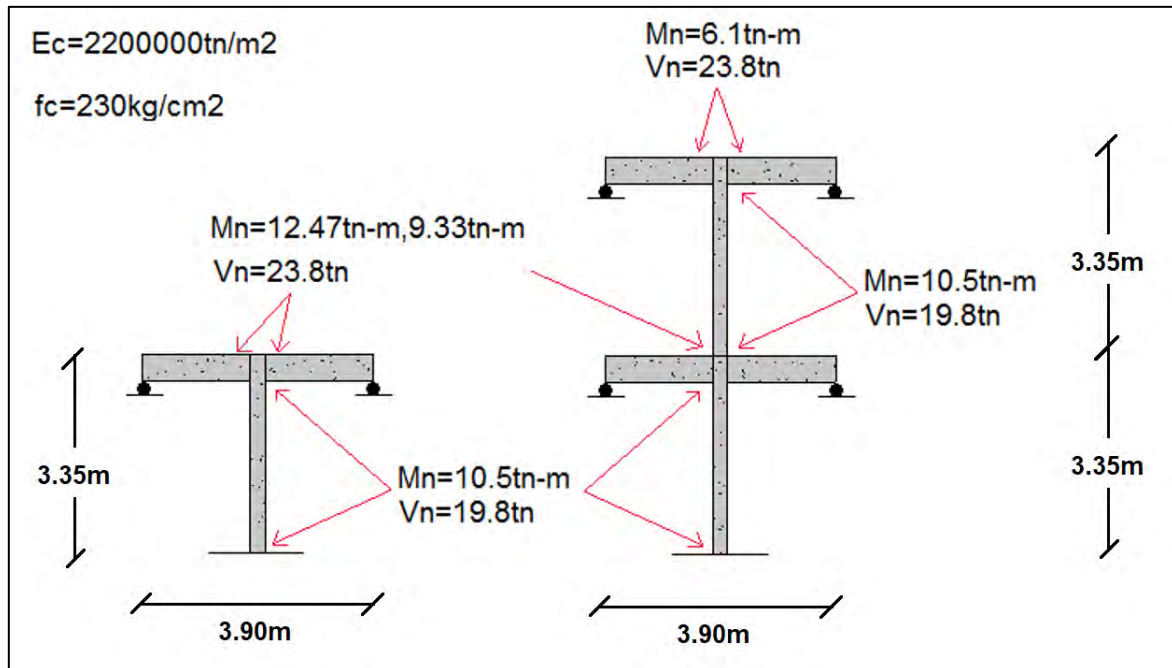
Pórtico simplificado para un nivel y dos niveles, con los momentos nominales de las secciones de concreto en las columnas y vigas.
